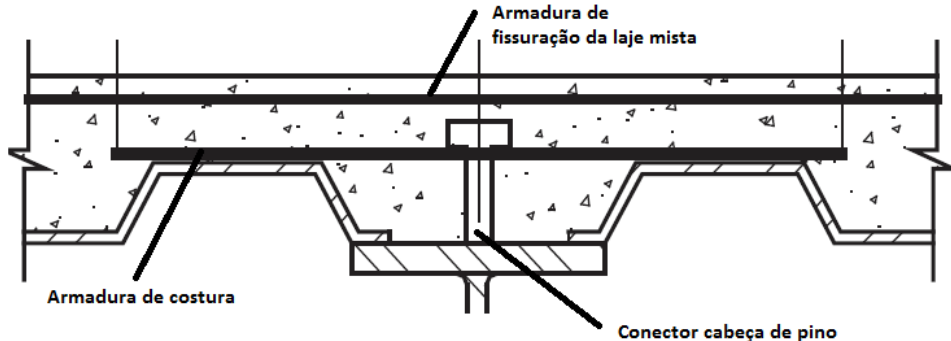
Armaduras transversais consideradas no cálculo de $H_{v,Rd}$, (Adaptado FACKURY *et al*, 2016).
